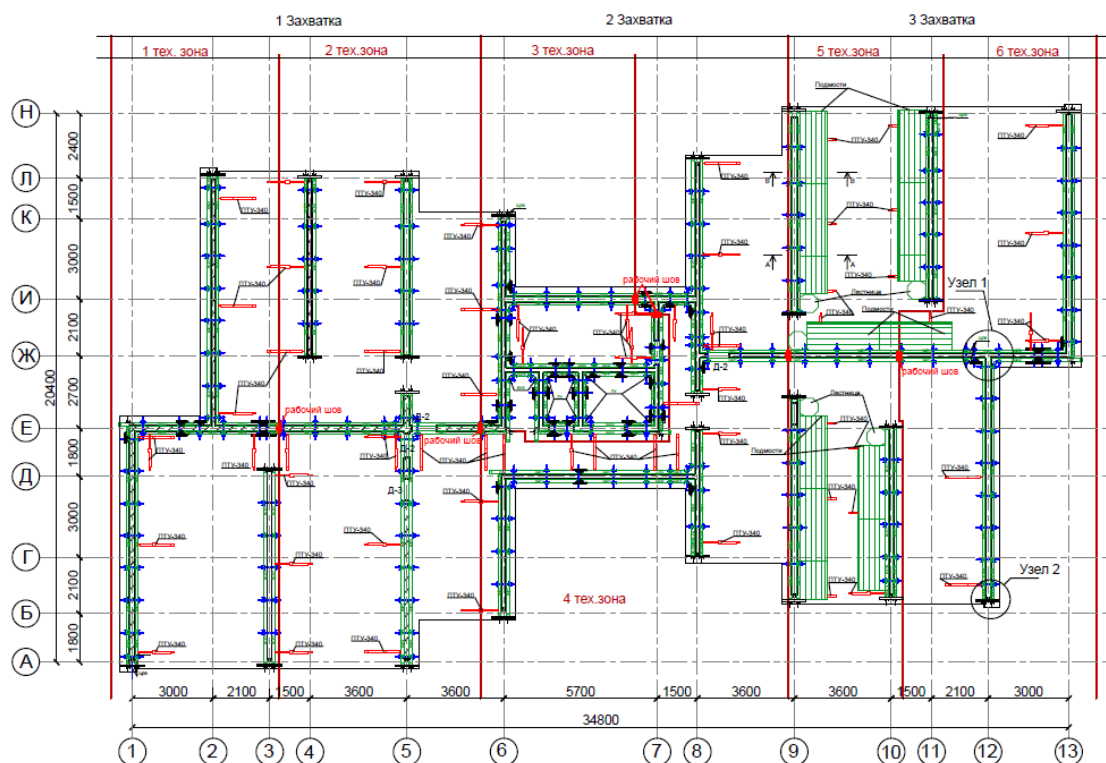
Схема расстановки опалубки вертикальных конструкций
